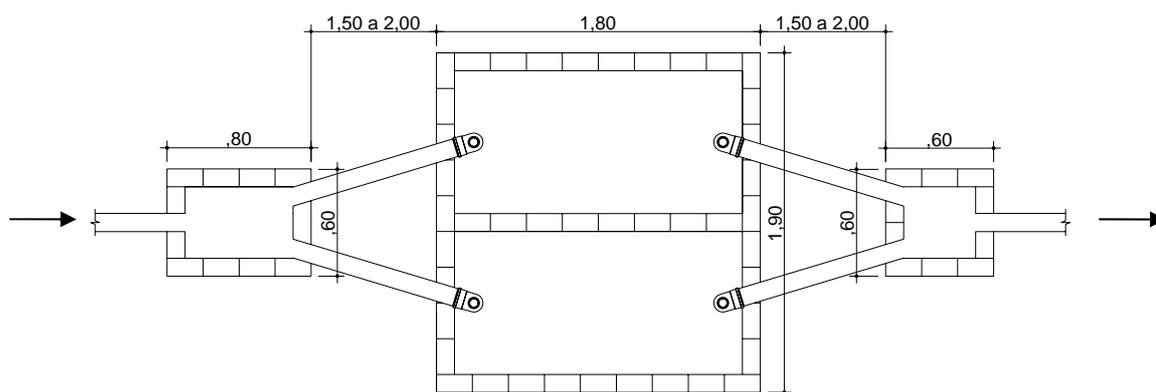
Detalhe do sistema de ligação entre as duas fossas, com caixa de passagem. Dimensões em metros (m).
